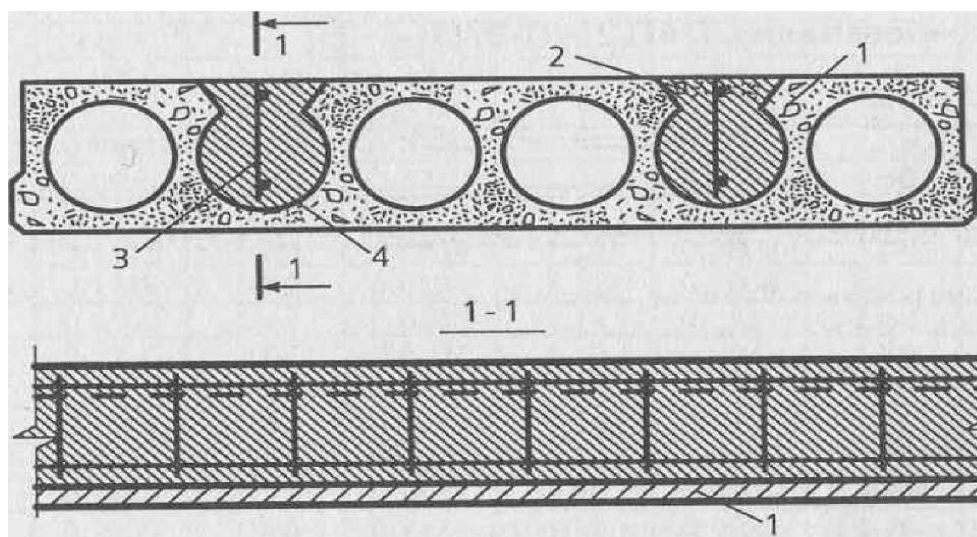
Усиление пустотных плит перекрытия и покрытия:
